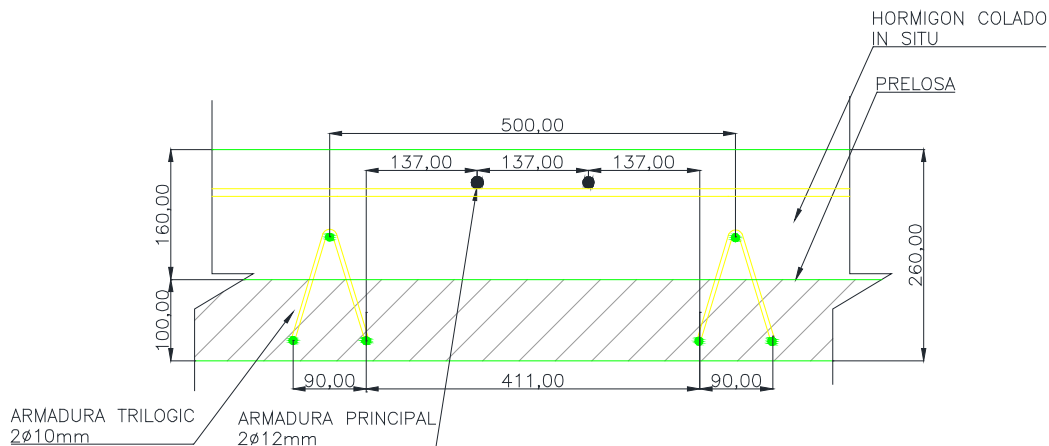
Esquema de armaduras inferiores (fuente: elaboración propia).
